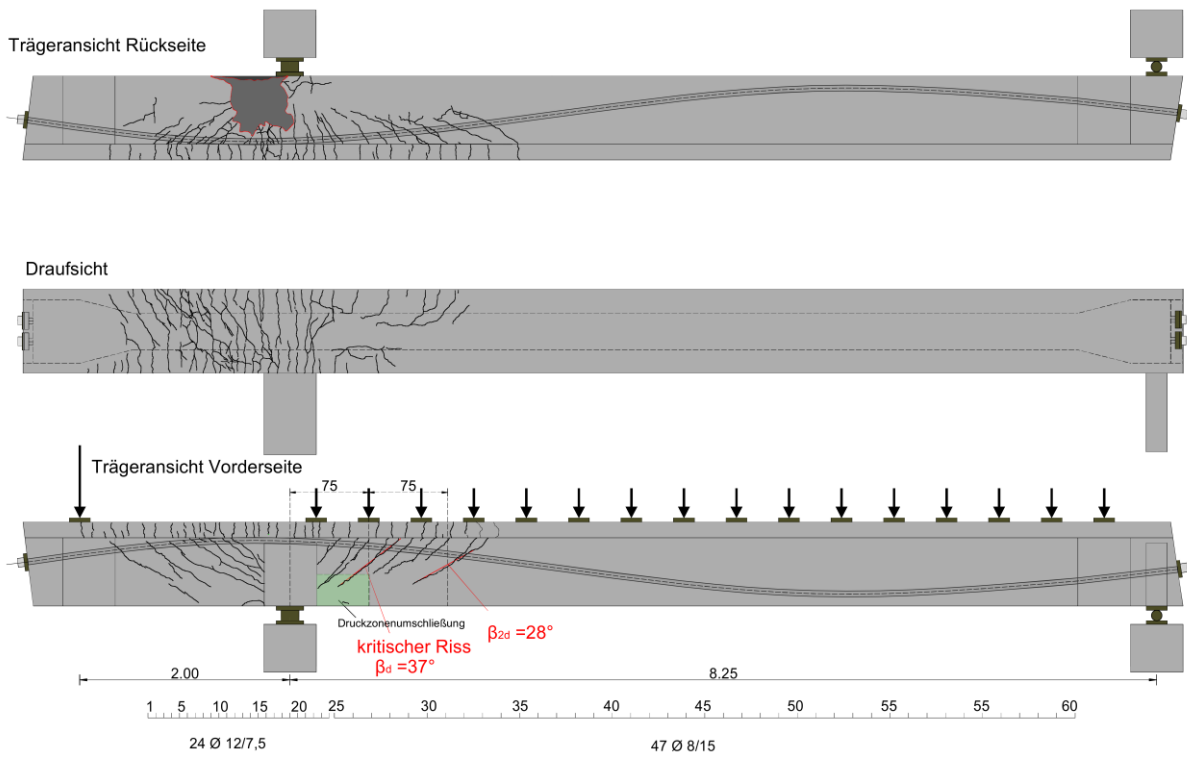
ETK2 Rissbilder unter Bruchlast
